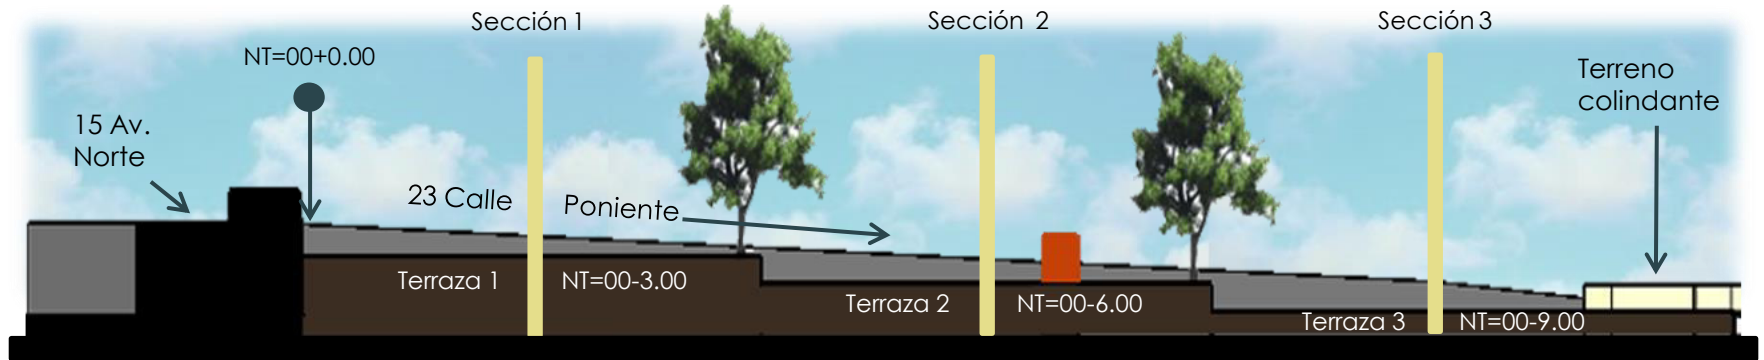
VISTA HACIA EL NORTE . Sección general Terrazas. Elaboración Propia.
